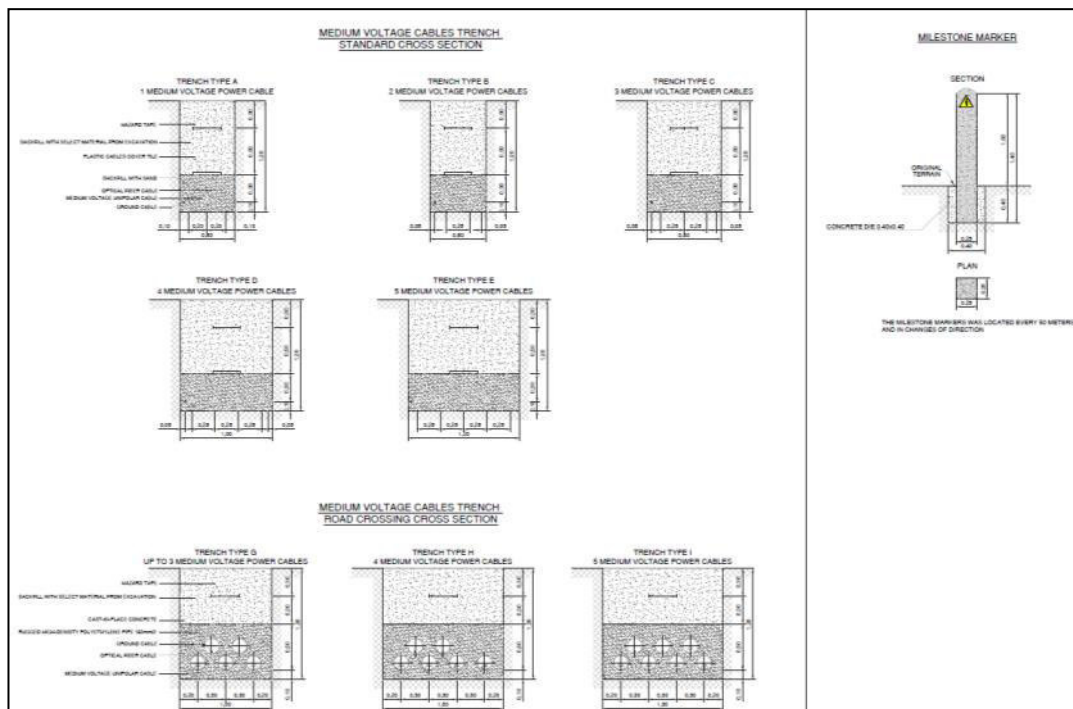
Perfil de zanja para circuito interno en 33KV. Fuente WASA
